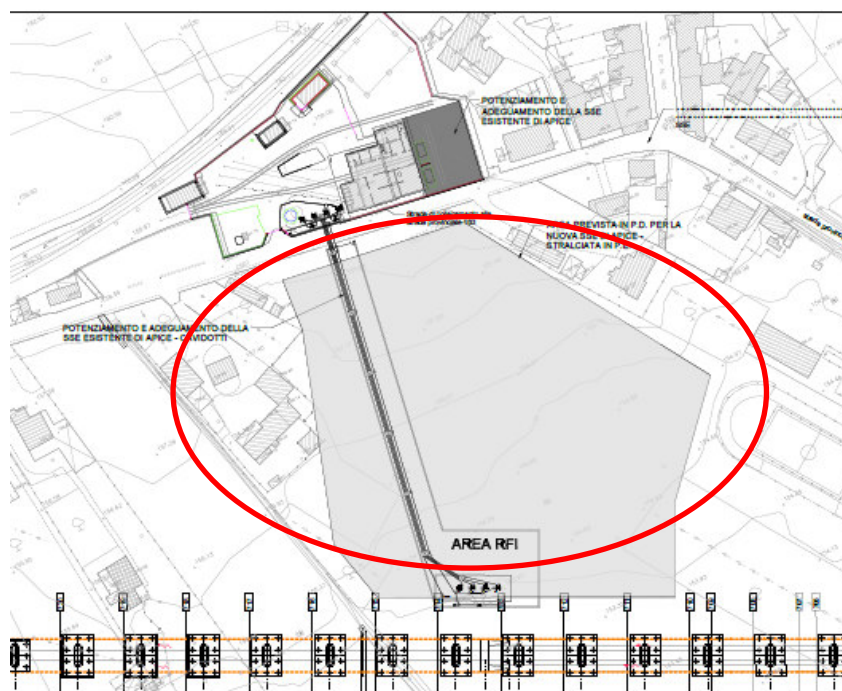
Planimetria della SSE Apice come da prescrizione in oggetto
